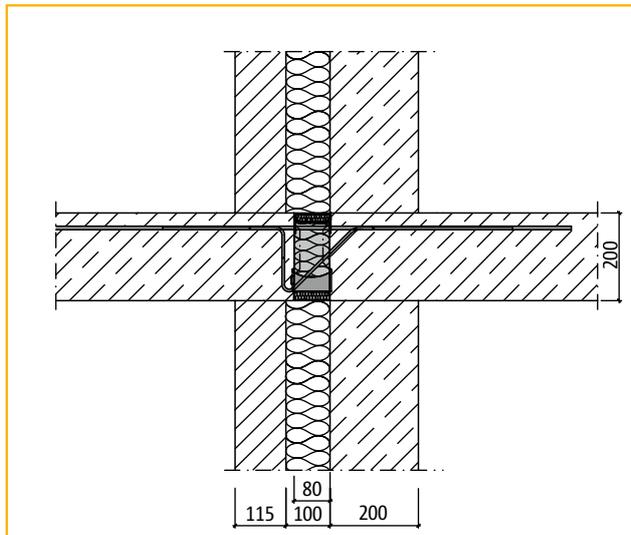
а: Соединение балконной плиты с использованием Schöck Isokorb® тип K30-CV30 для системы с теплоизоляцией
